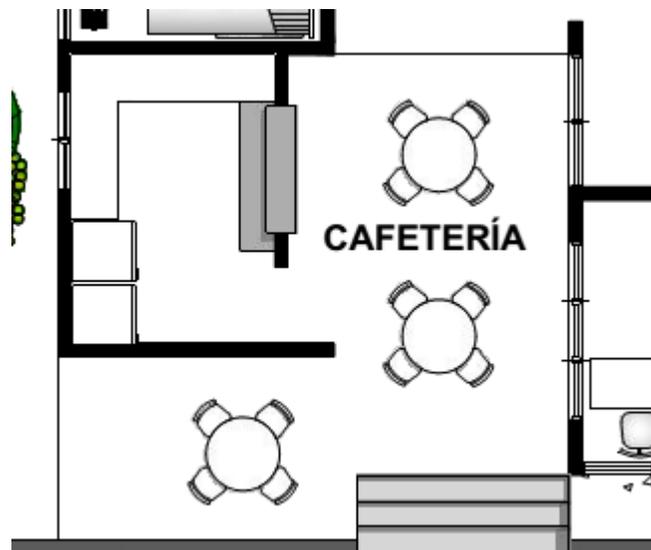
Diseño de construcción de cafetería. Fuente: Propia
